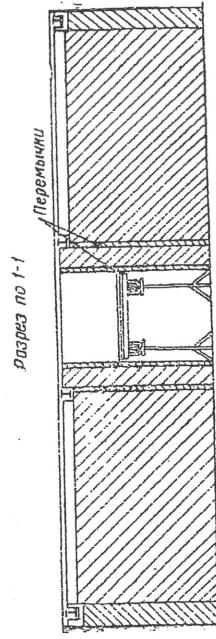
Продолжение третьего этапа — кладка коридорных стен до плиты перекрытия
